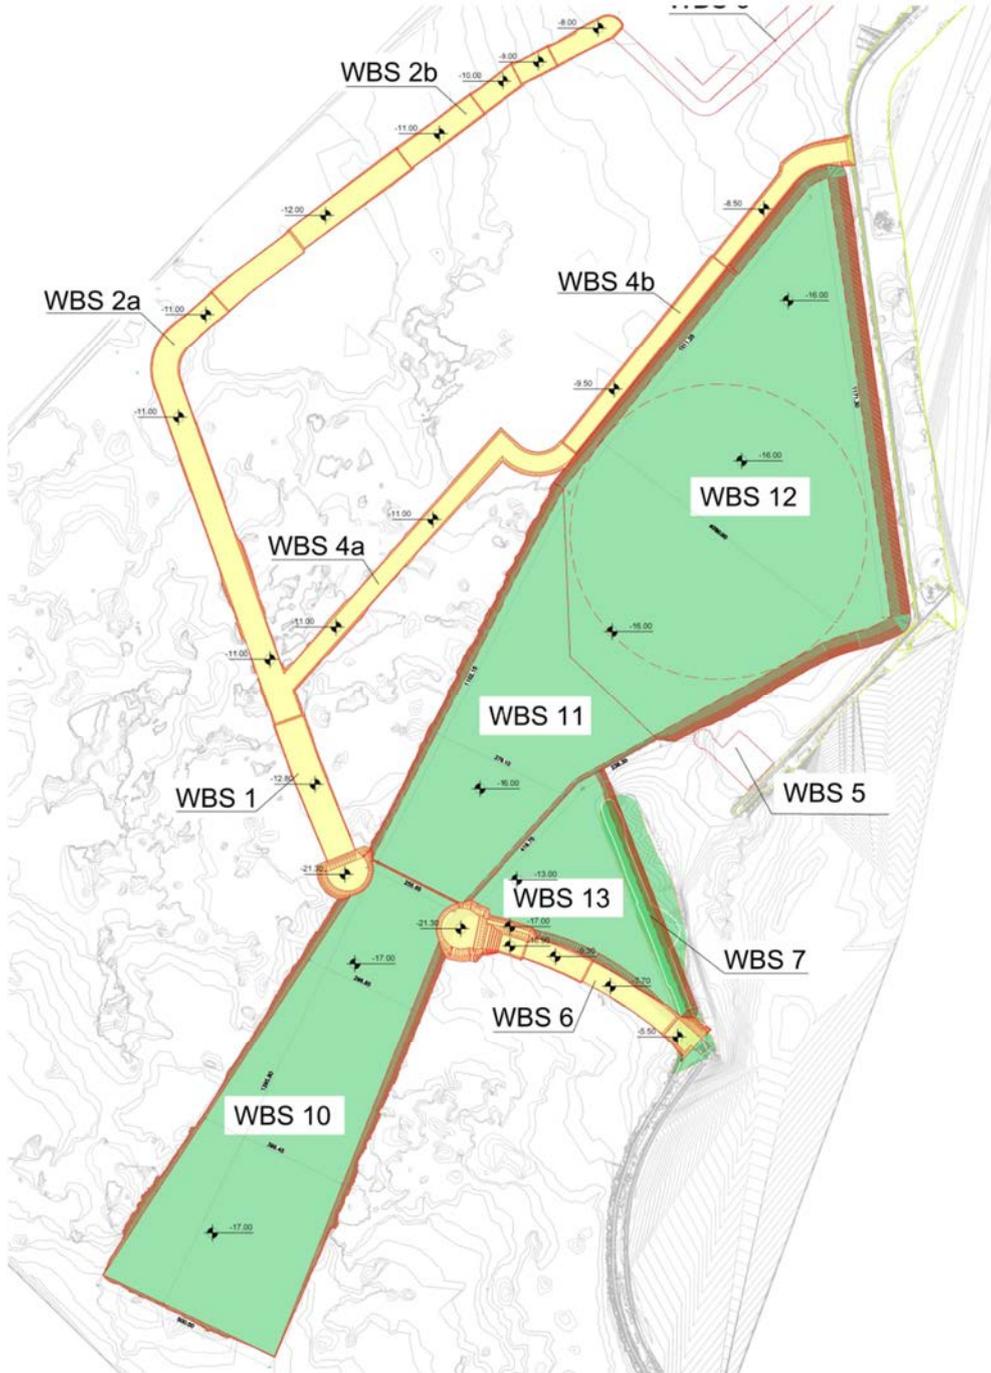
Planimetria aree di rilievo e profondità di dragaggio
